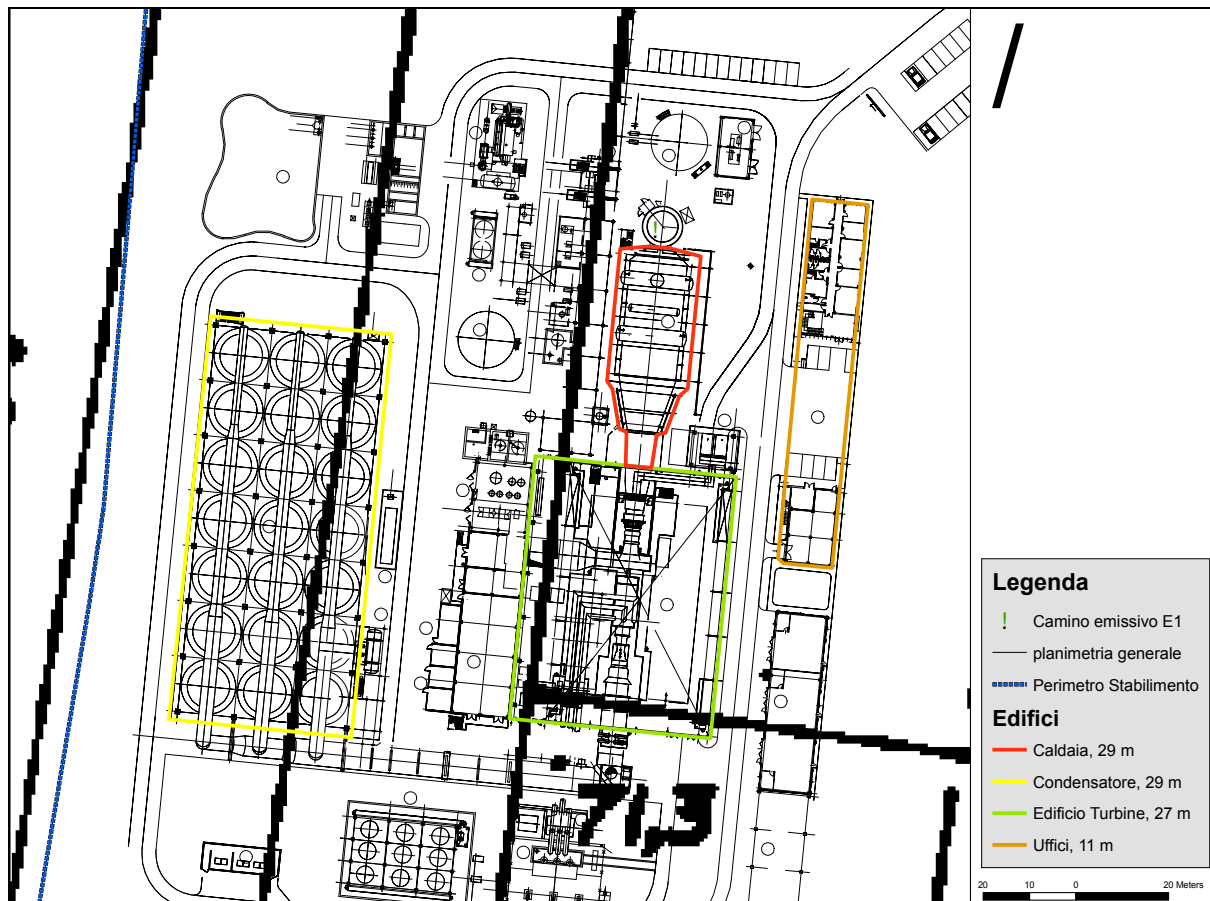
Effetto "Building downwash": zoom sugli edifici considerati
